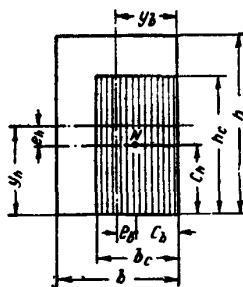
Расчетная схема прямоугольного сечения при косом внецентренном сжатии
